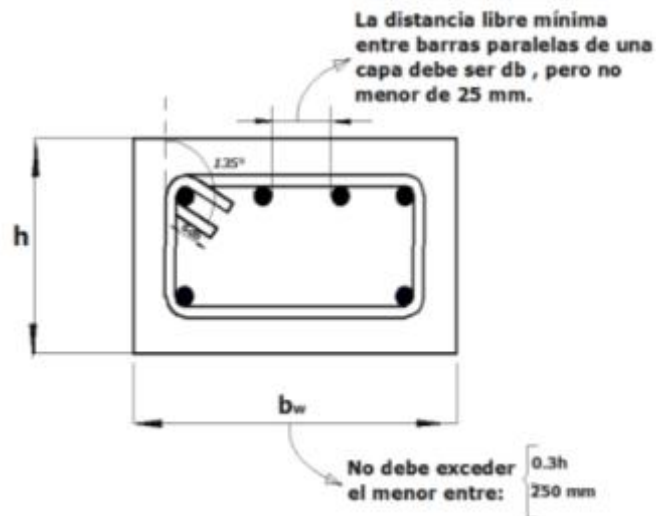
Límite de espaciamiento de refuerzo y ancho mínimo de una viga
